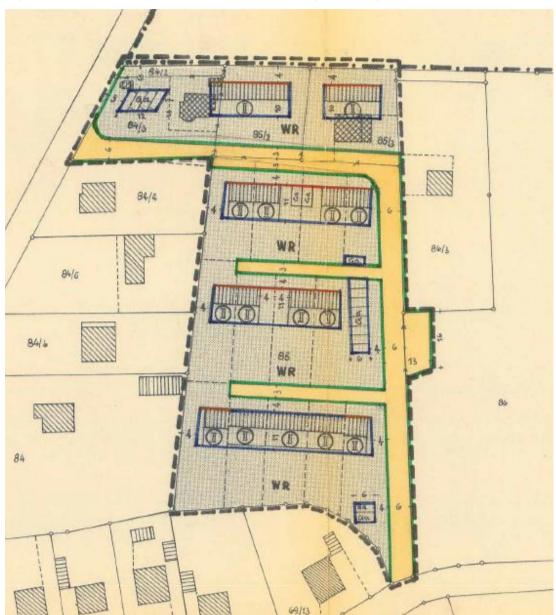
Bebauungsplan Nr. 11&5 "nördlich der Michlbauerstraße" i.d.F. vom 07.09.1966
